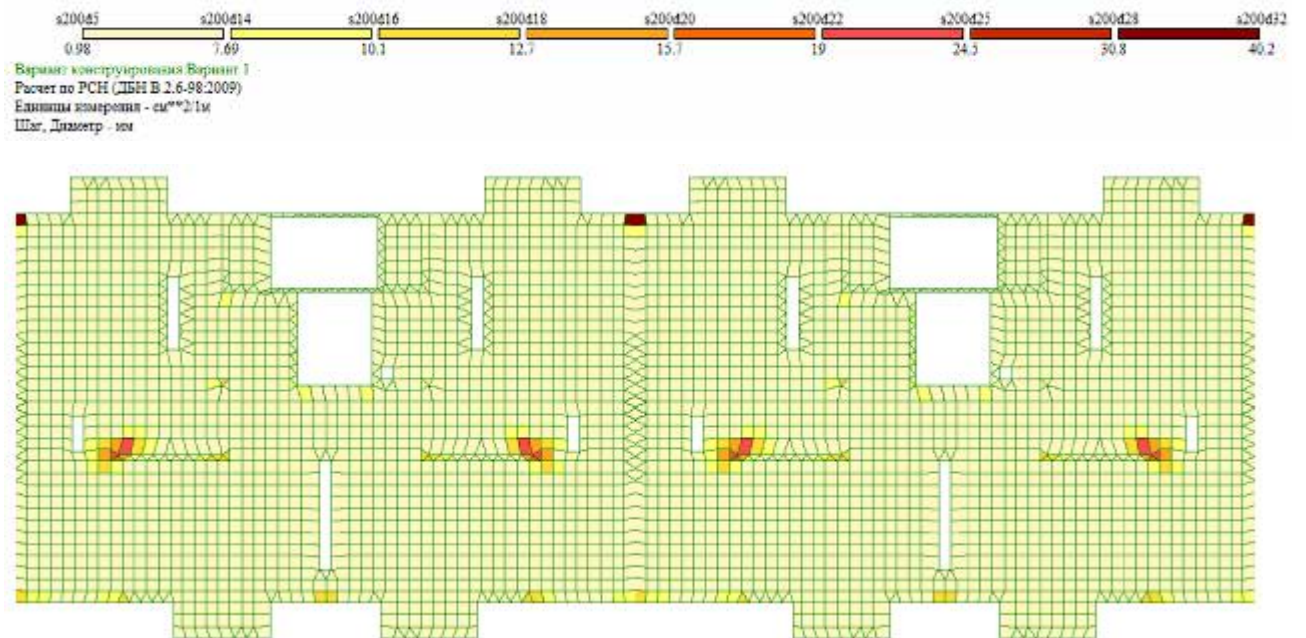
Армирование плиты по верхней грани по оси Y.
